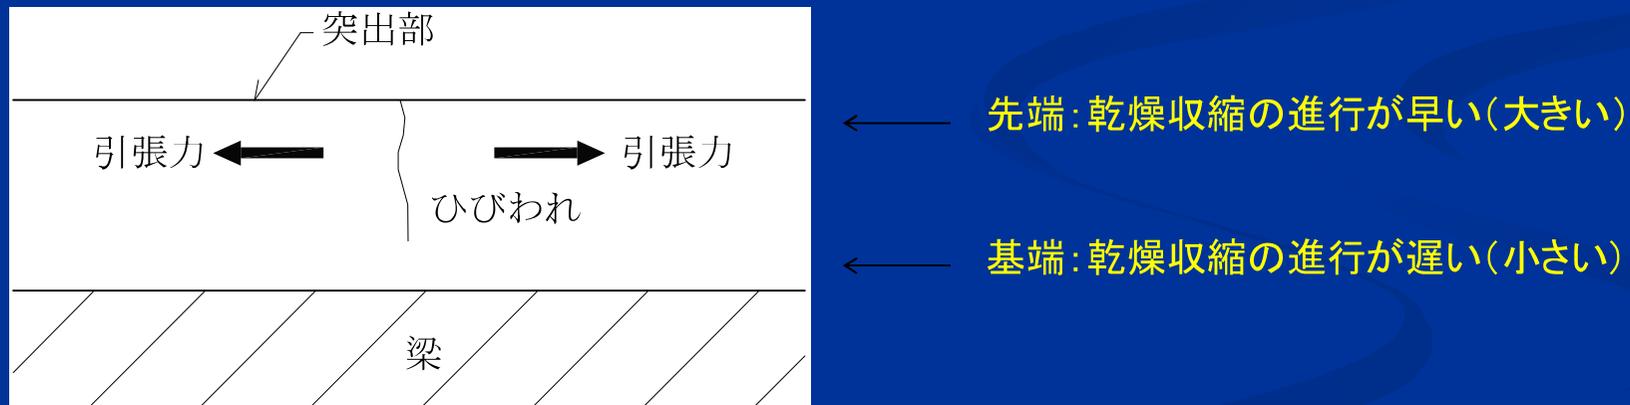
壁やスラブの突出部に発生するひび割れパターン
